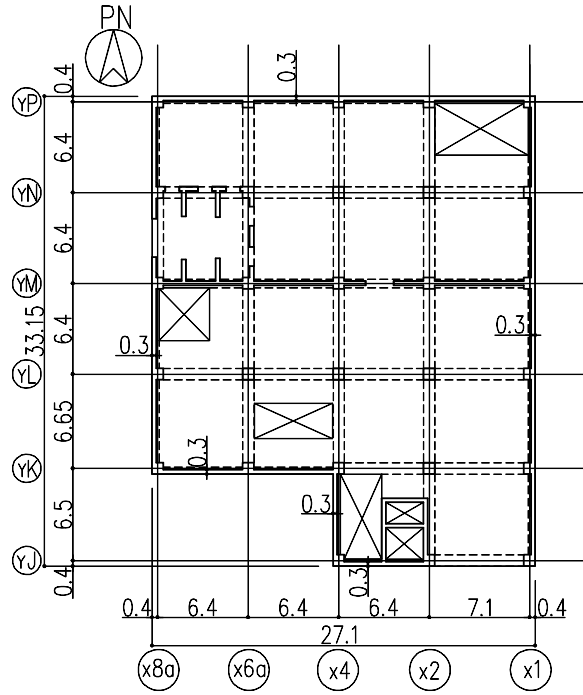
地上2階平面図 (G.L.+4.7) (单位:m)
